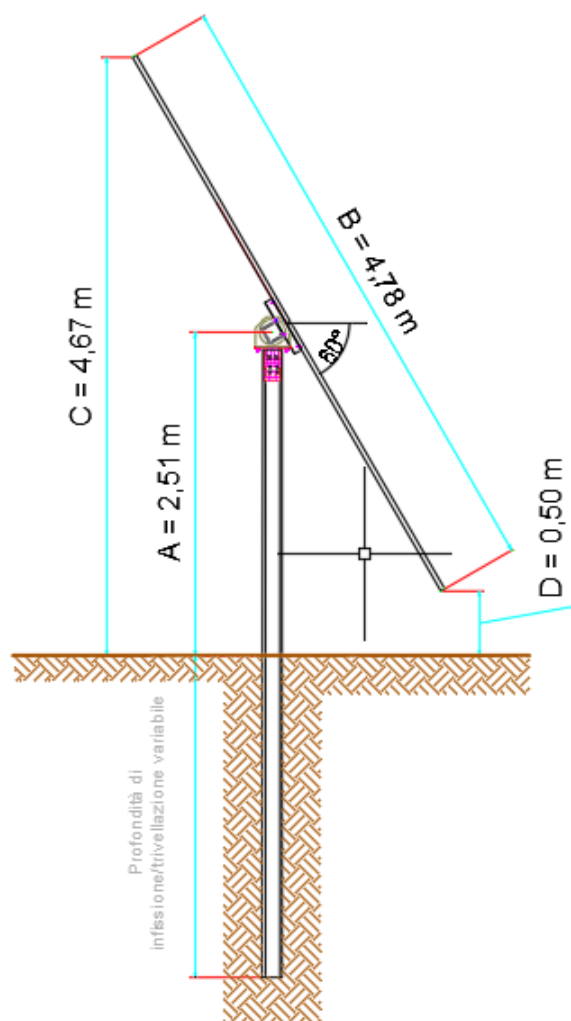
Vista laterale moduli fotovoltaici montati su strutture a inseguimento (stralcio dell'elaborato PD-G.2.3.3)
